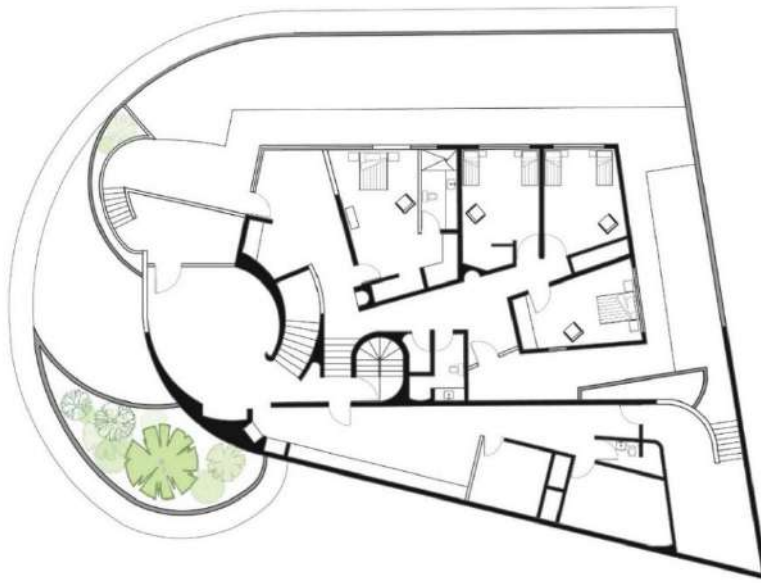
Planimetría Casa Calderón, primera planta. Tomado de: Erazco, A. (2016). Edición: La Autora (2021).
